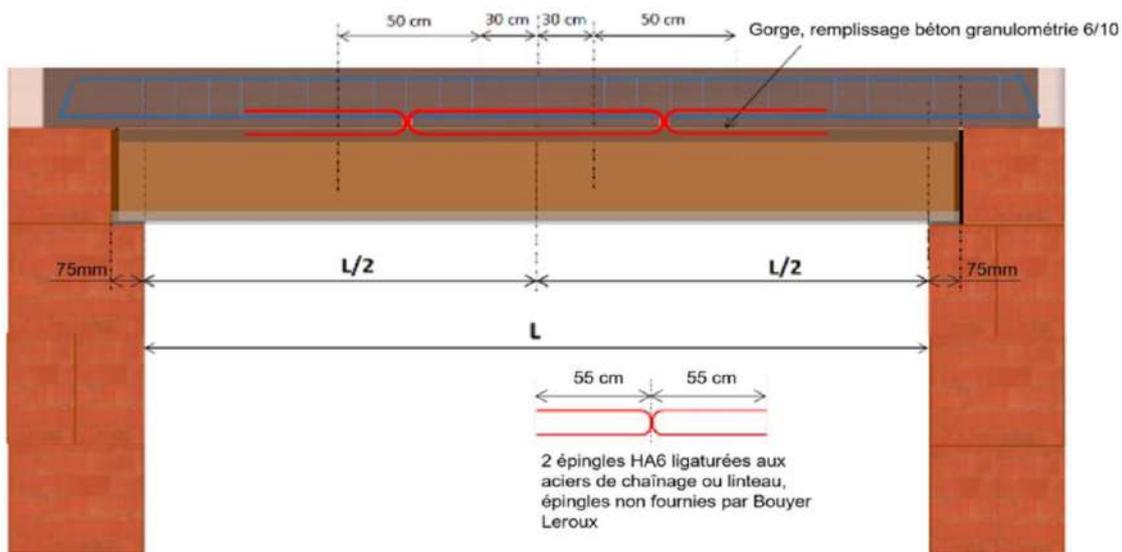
Liaison mécanique avec le linteau ou la dalle
